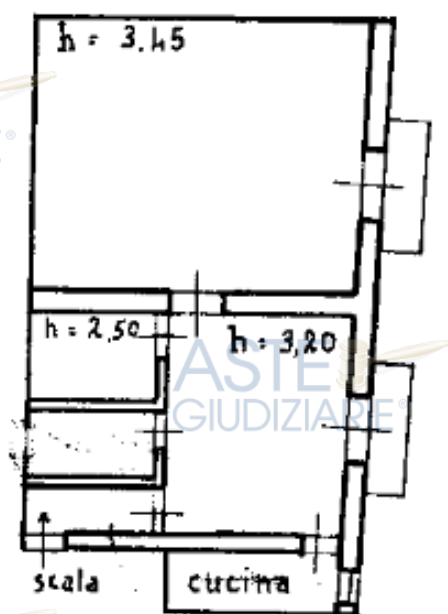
Estratto planimetria catastale del 22.12.1939.
